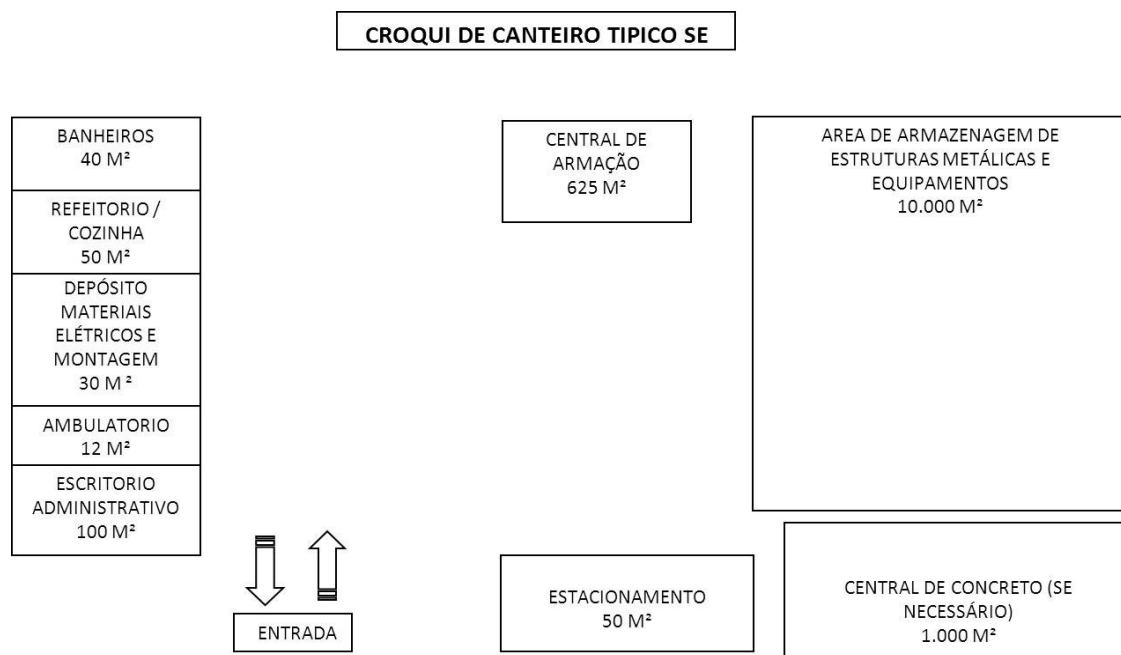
Layout de Canteiro de Obra típico de SE.
